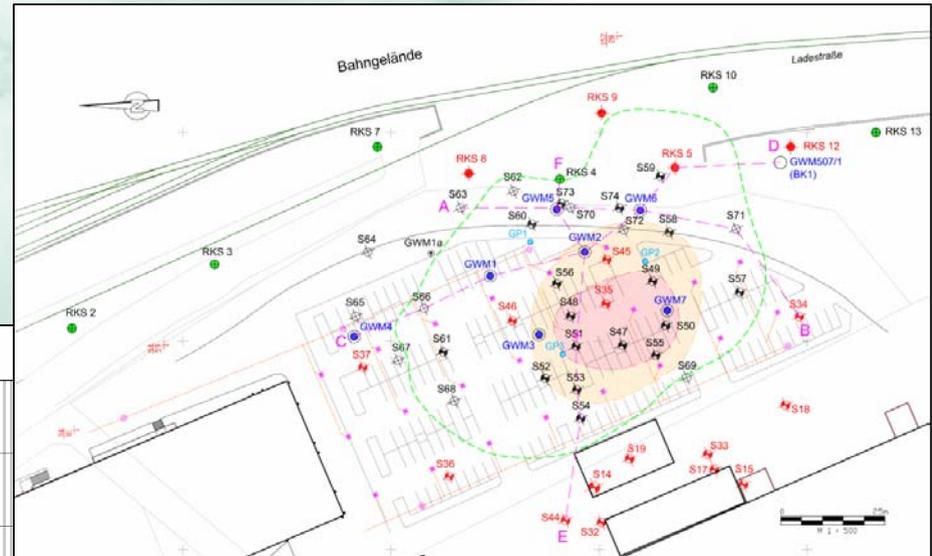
Lageplan Altablagerung [DAS-IB GmbH, 2009]
